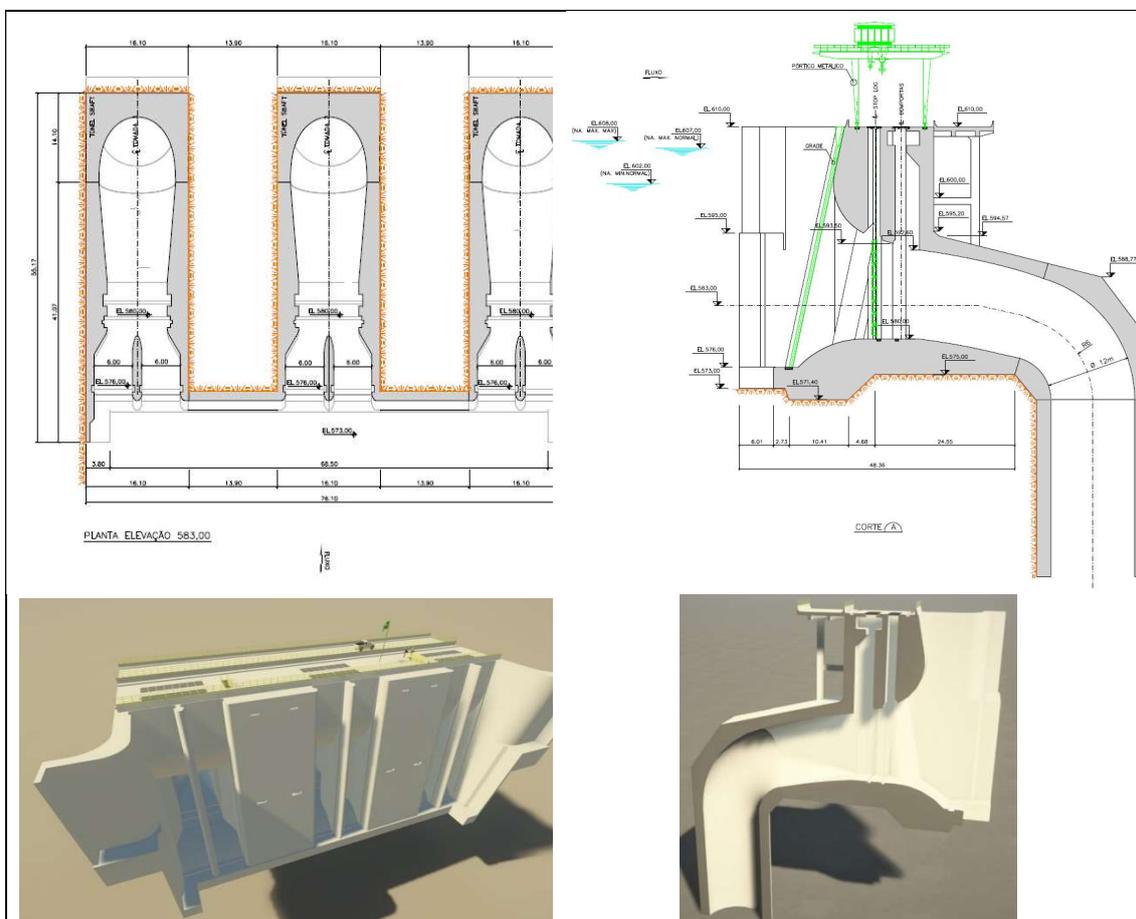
Planta, corte e perspectivas da estrutura da Tomada de Água
